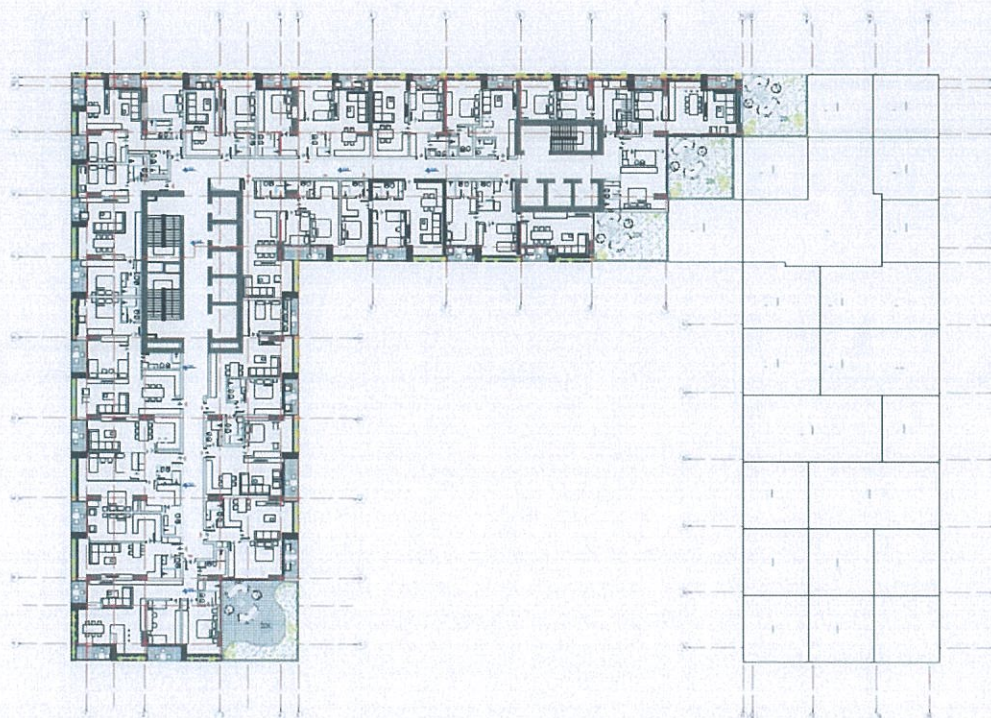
Planimetria e katit të parë, në kuotën +5.76
